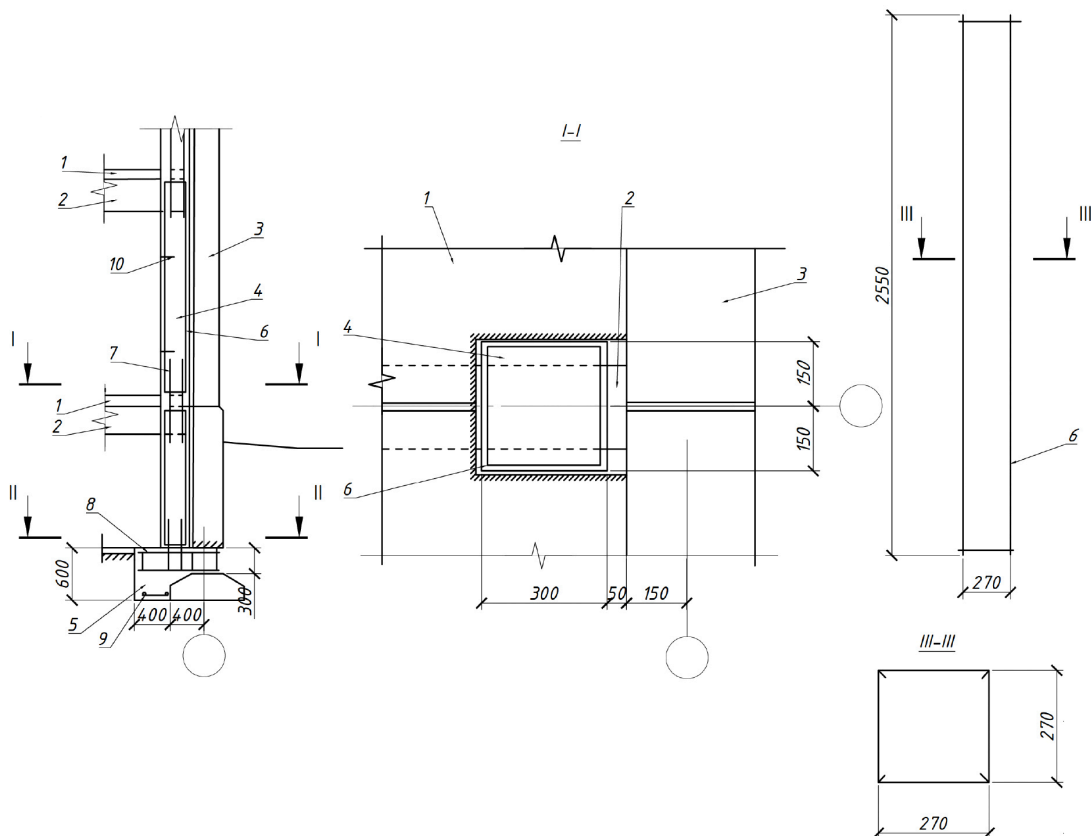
Устройство монолитной колонны. Разрез по наружной стене: 1 – существующая панель перекрытия; 2 – существующий прогон; 3 – наружная стена; 4 – монолитная колонна; 5 – монолитный фундамент колонны; 6 – пространственный каркас колонны; 7 – соединительные стержни; 8 – пространственный каркас фундамента; 9 – арматурная сетка; 10 – закладная деталь
